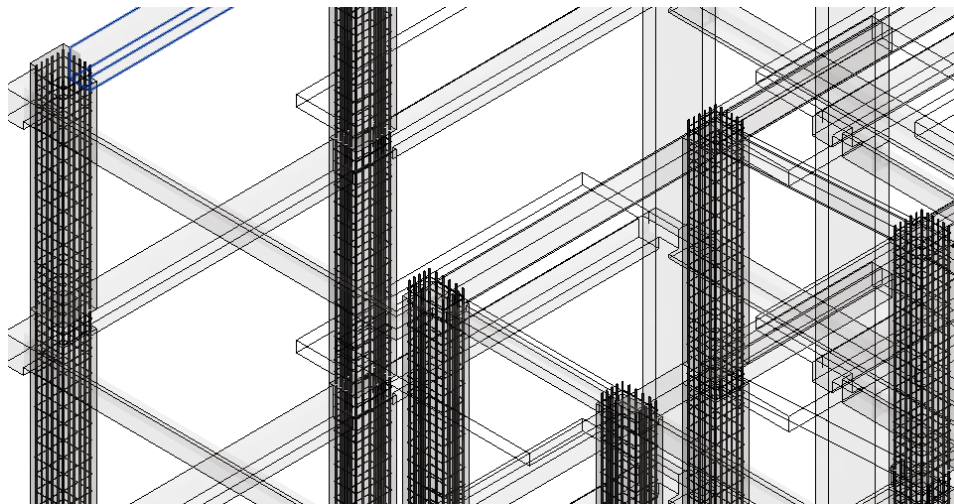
Vista parcial dos modelos de armadura em pilares
